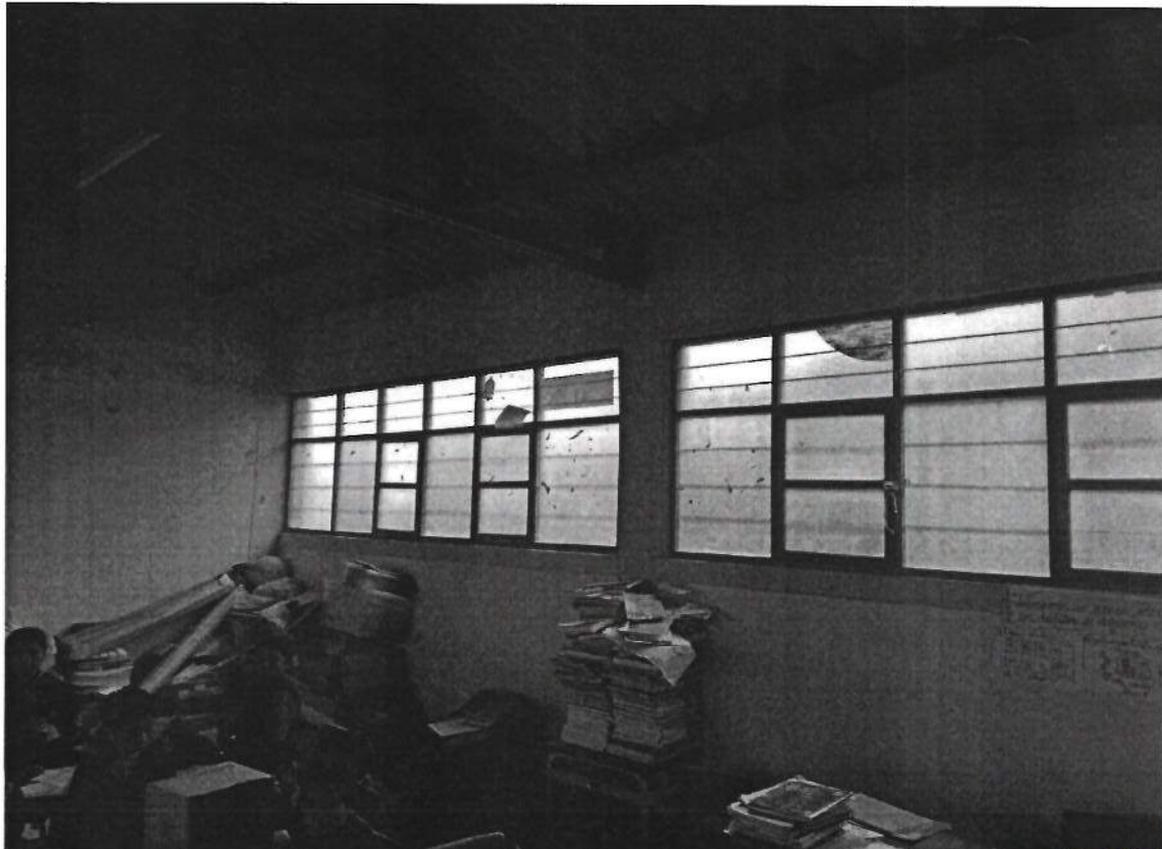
(Vista interior) Los ambientes no presentan fisuras, grietas ni otro tipo de daños en elementos estructurales ni en vaños. Se observa la cobertura liviana de fibrocemento sobre estructura metálica apoyada en vigas de concreto. Se observa además vidrios rotos y pintura en muros deteriorada.
